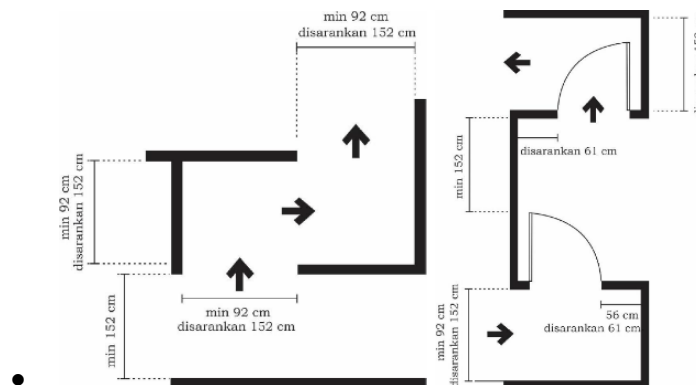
Lebar Efektif Pintu serta Ruang Bebas di Dalam Ruang dan di Luar ruangan/koridor/selasar
